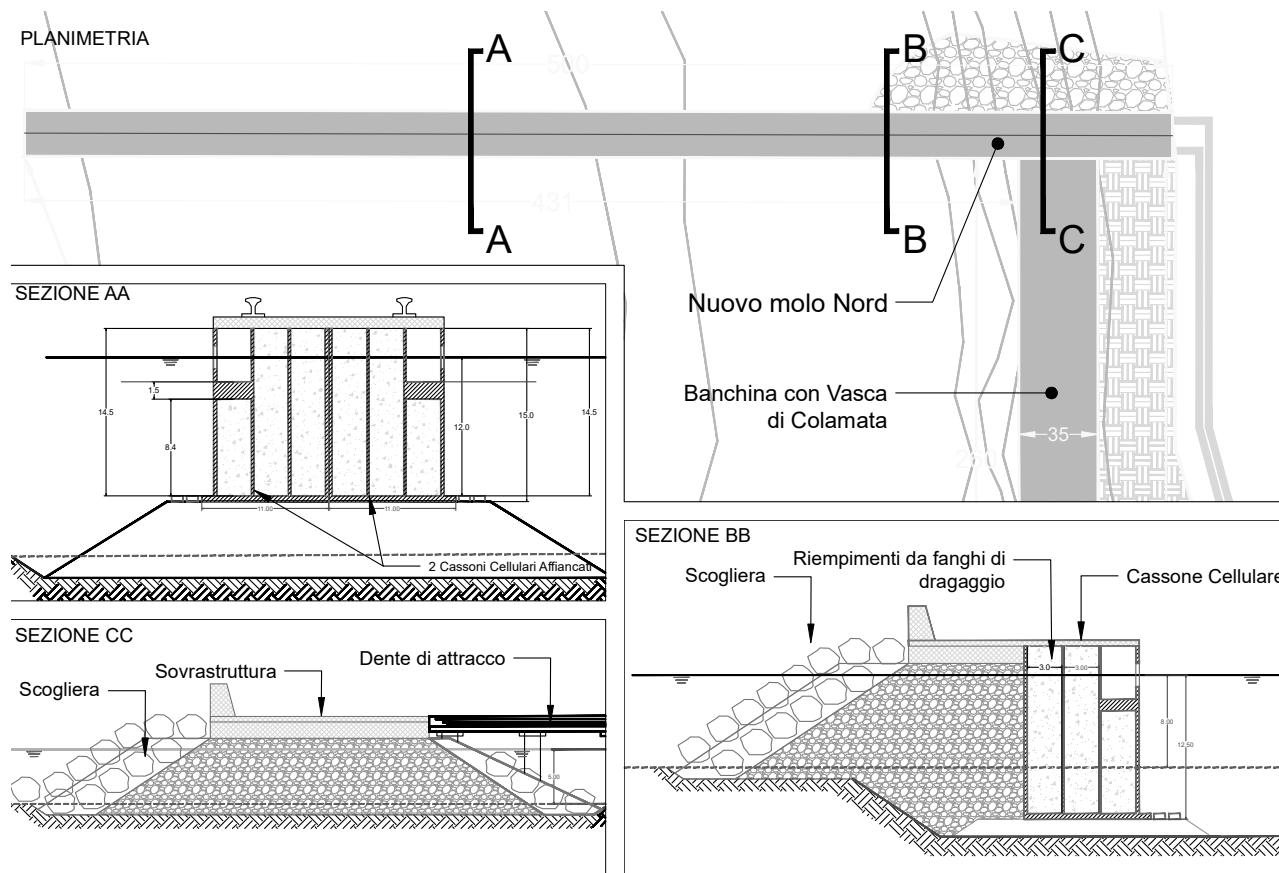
Planimetria sezioni nuovo molo Pugliese
